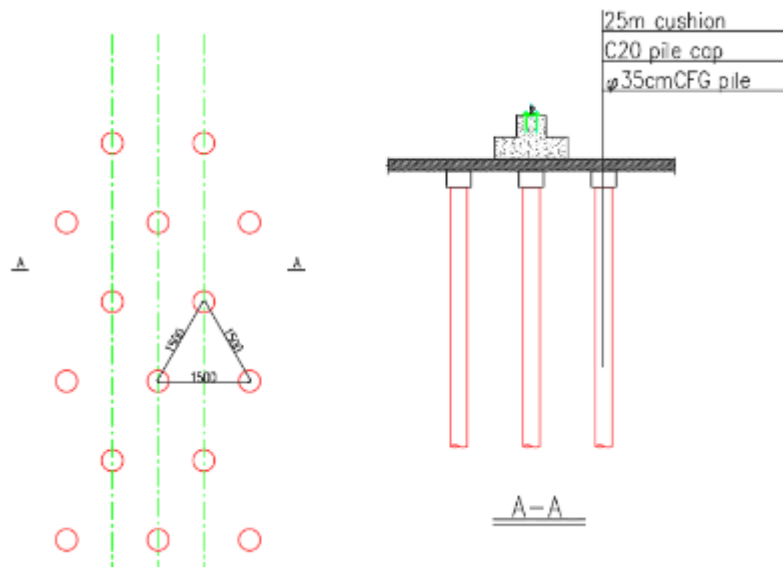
Disposición de la cimentación de pilas CFG en el patio de prefabricados
